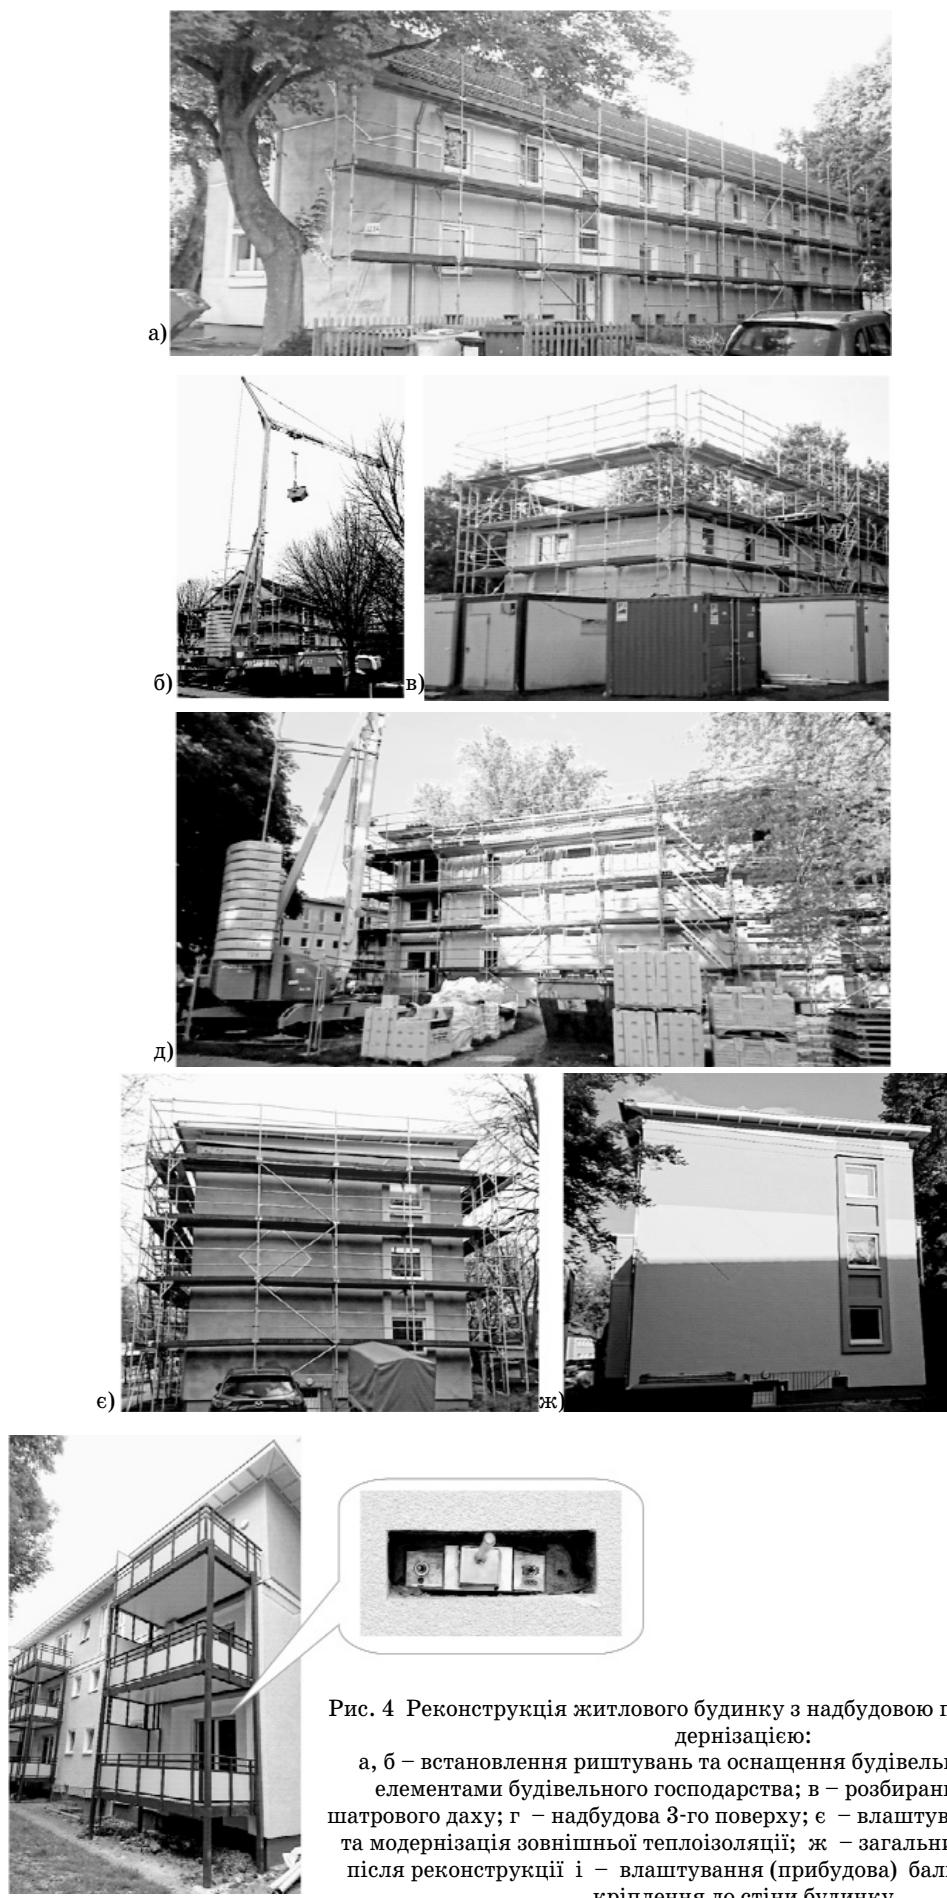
Реконструкція житлового будинку з надбудовою поверху та термомодернізацією:
